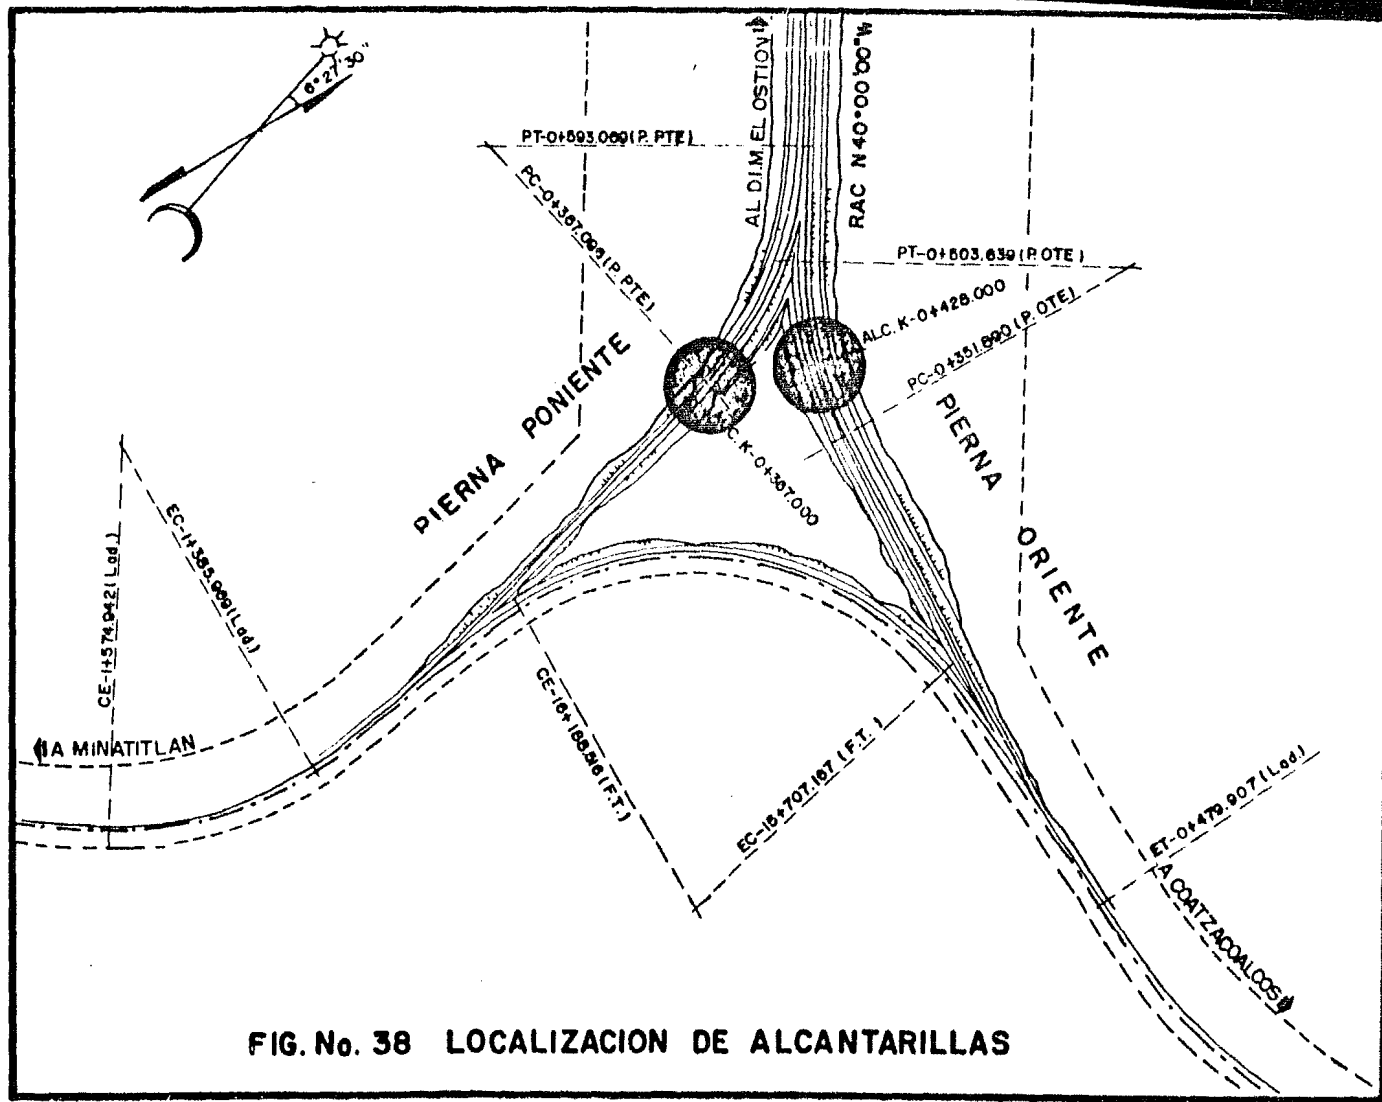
LOCALIZACION DE ALCANTARILLAS
